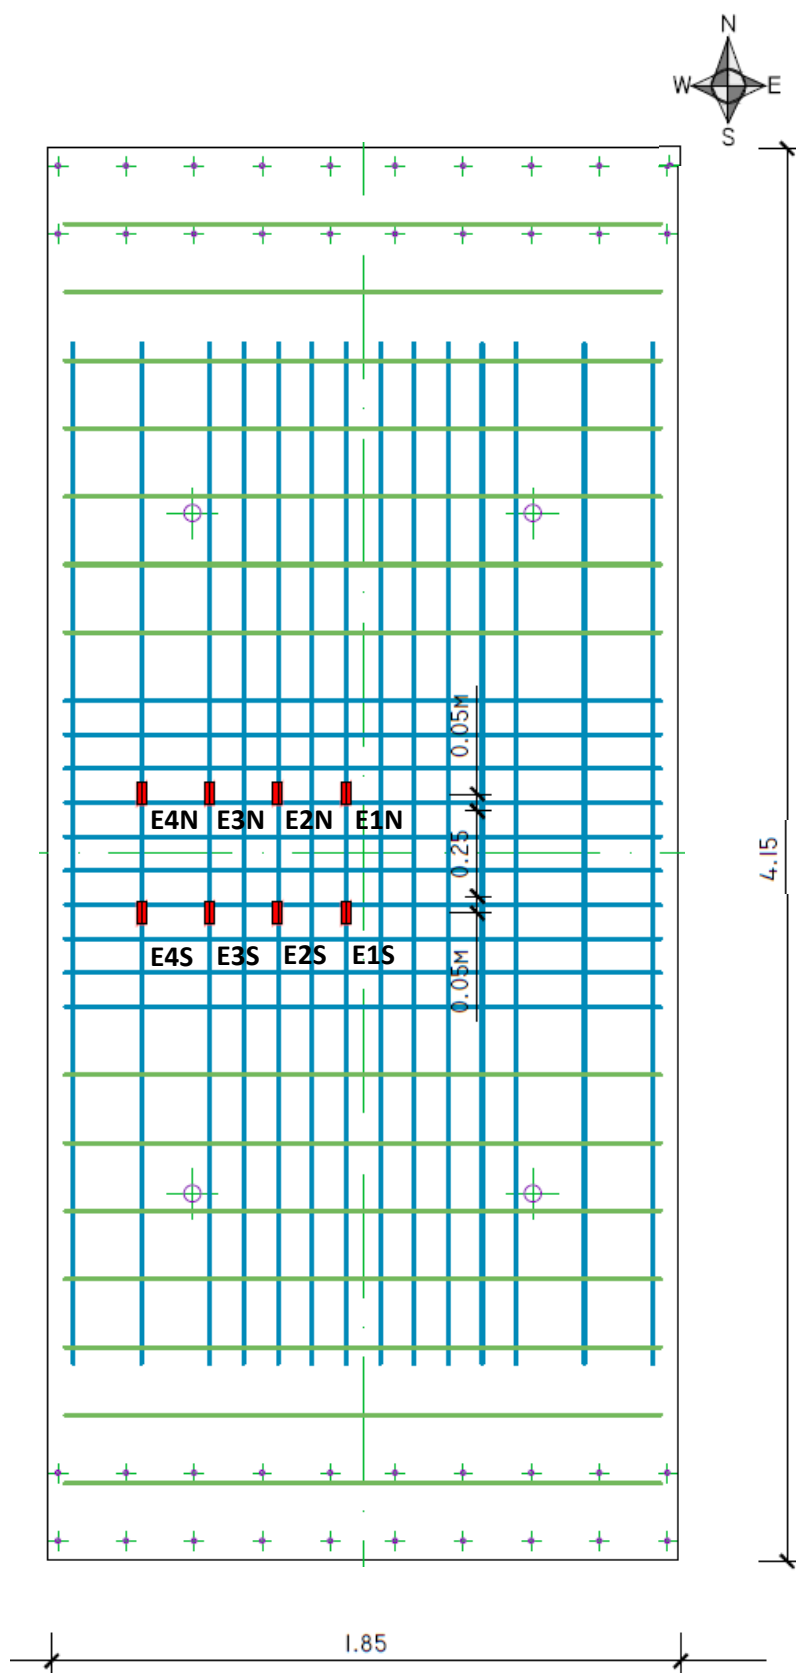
Localização dos extensômetros instalados na armadura longitudinal superior.
